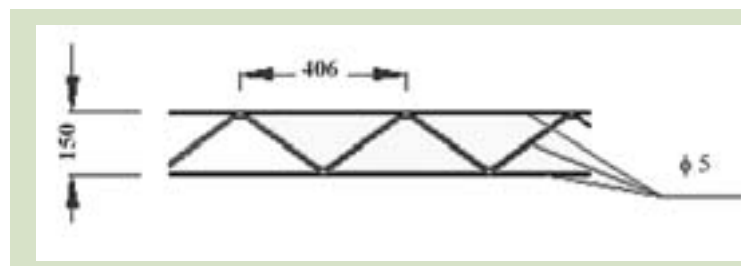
Traliccio Murfor RND/Z- 5-150 prodotto dalla Bekaert (misure in mm).
